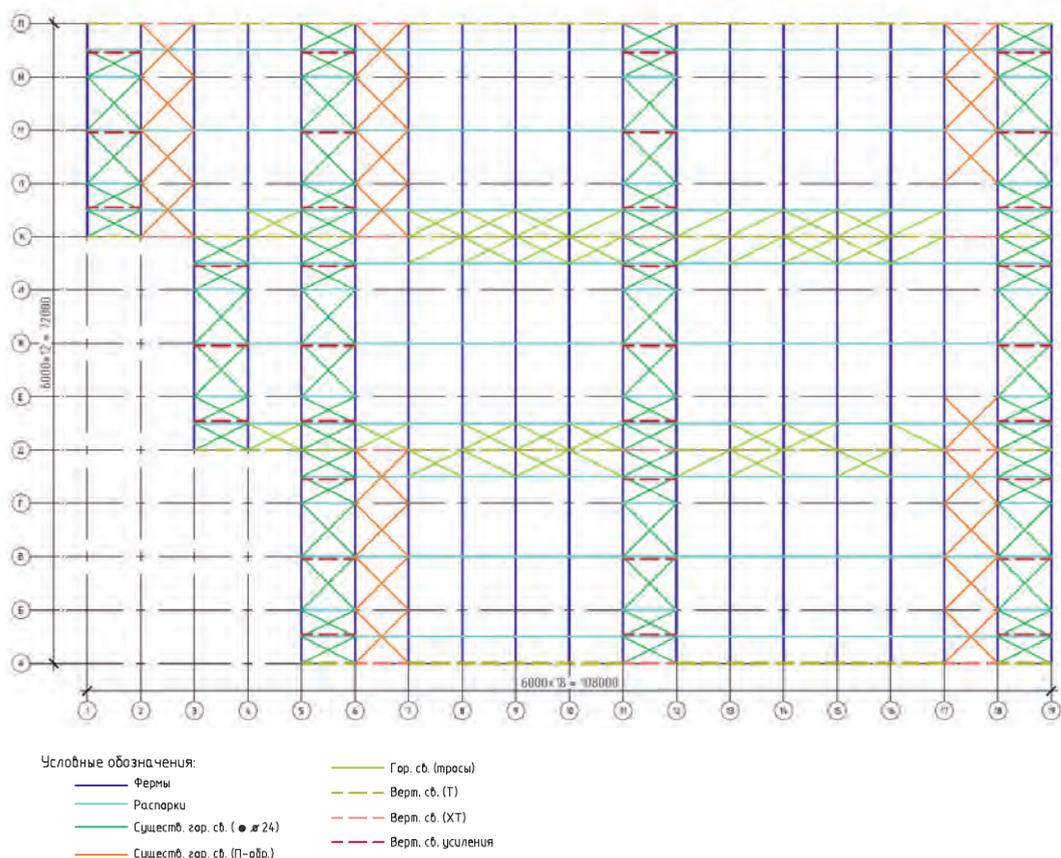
Существующее на декабрь 2018 г. расположение горизонтальных связей по нижним поясам стропильных ферм здания склада
